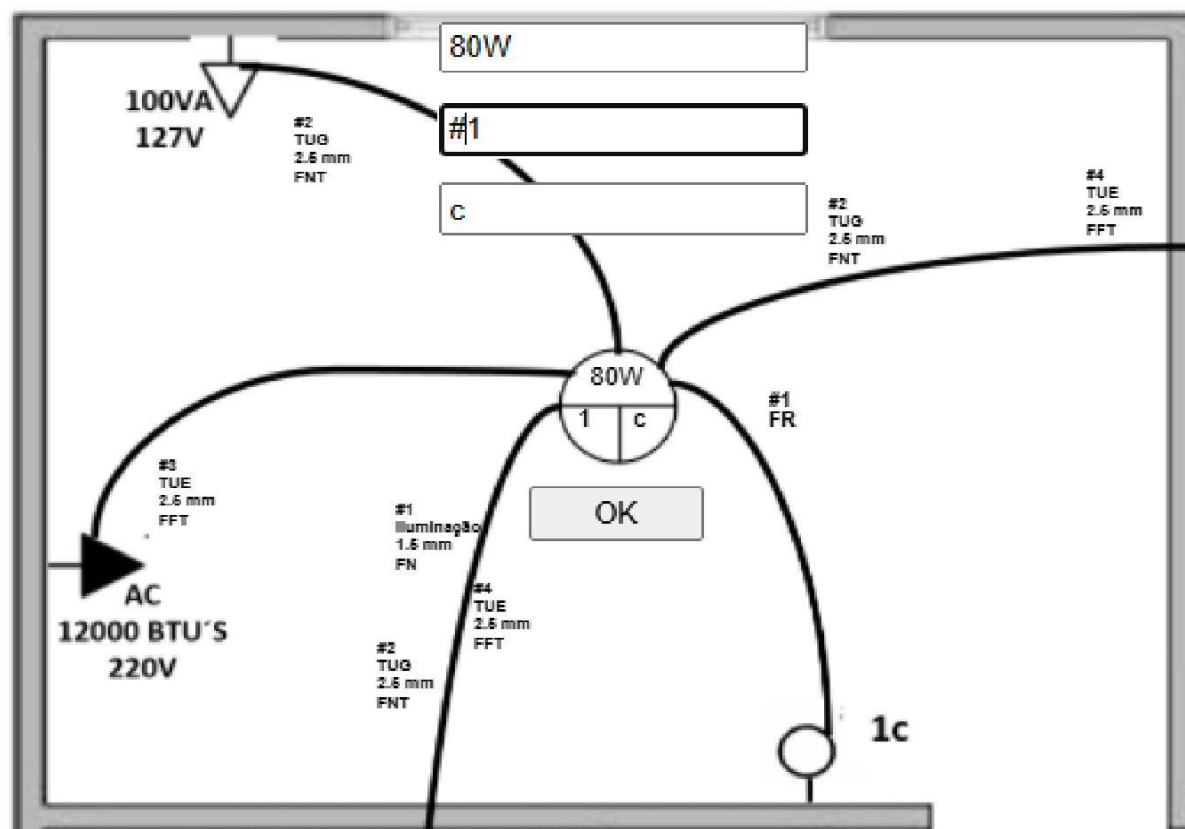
Imagem da planta com a opção de finalizar destacada.
